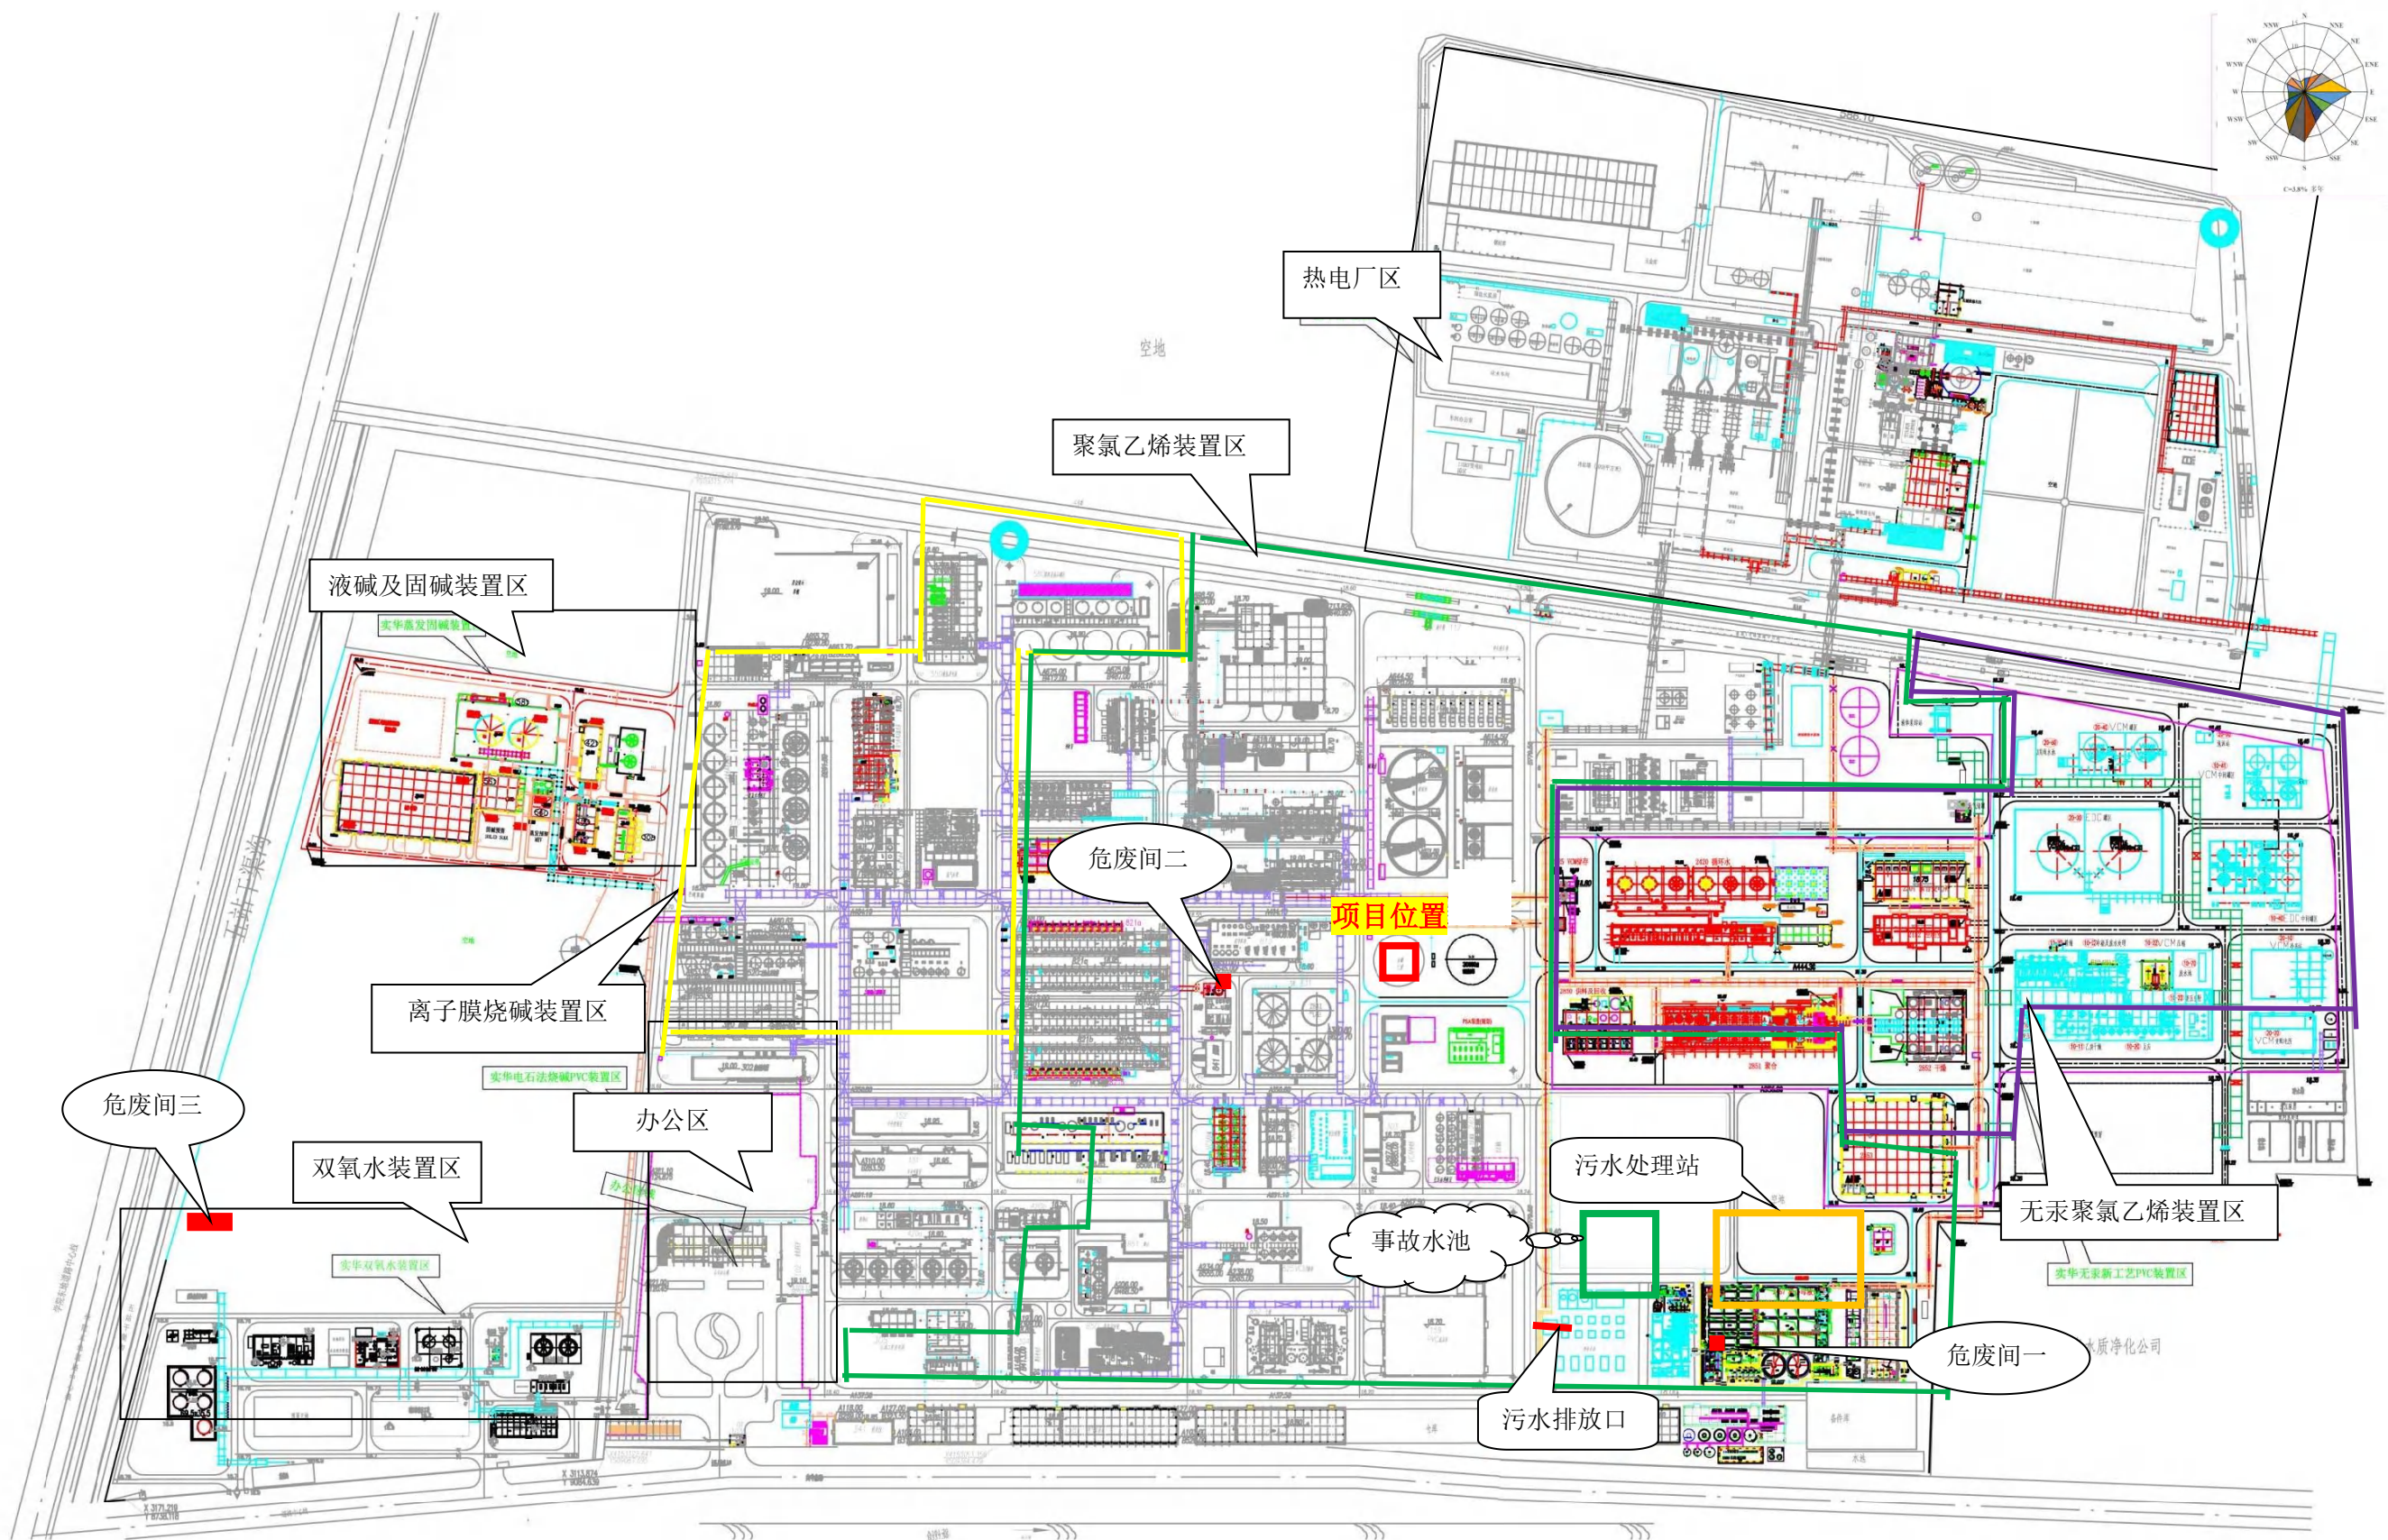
厂区总平面布置图 比例尺：1:1000
